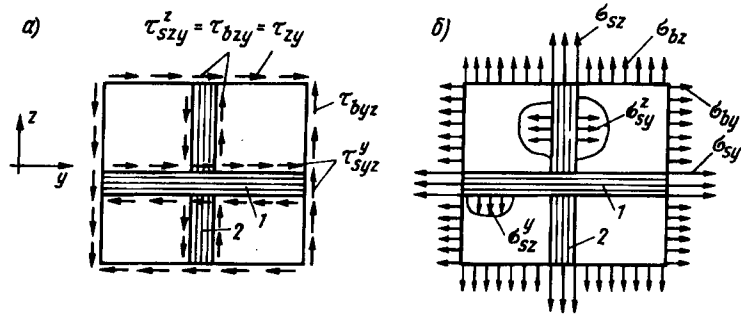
Касательные (а) и нормальные (б) напряжения в арматуре и бетоне до появления трещин 1, 2 — арматурные стержни, расположенные соответственно вдоль осей y и z
